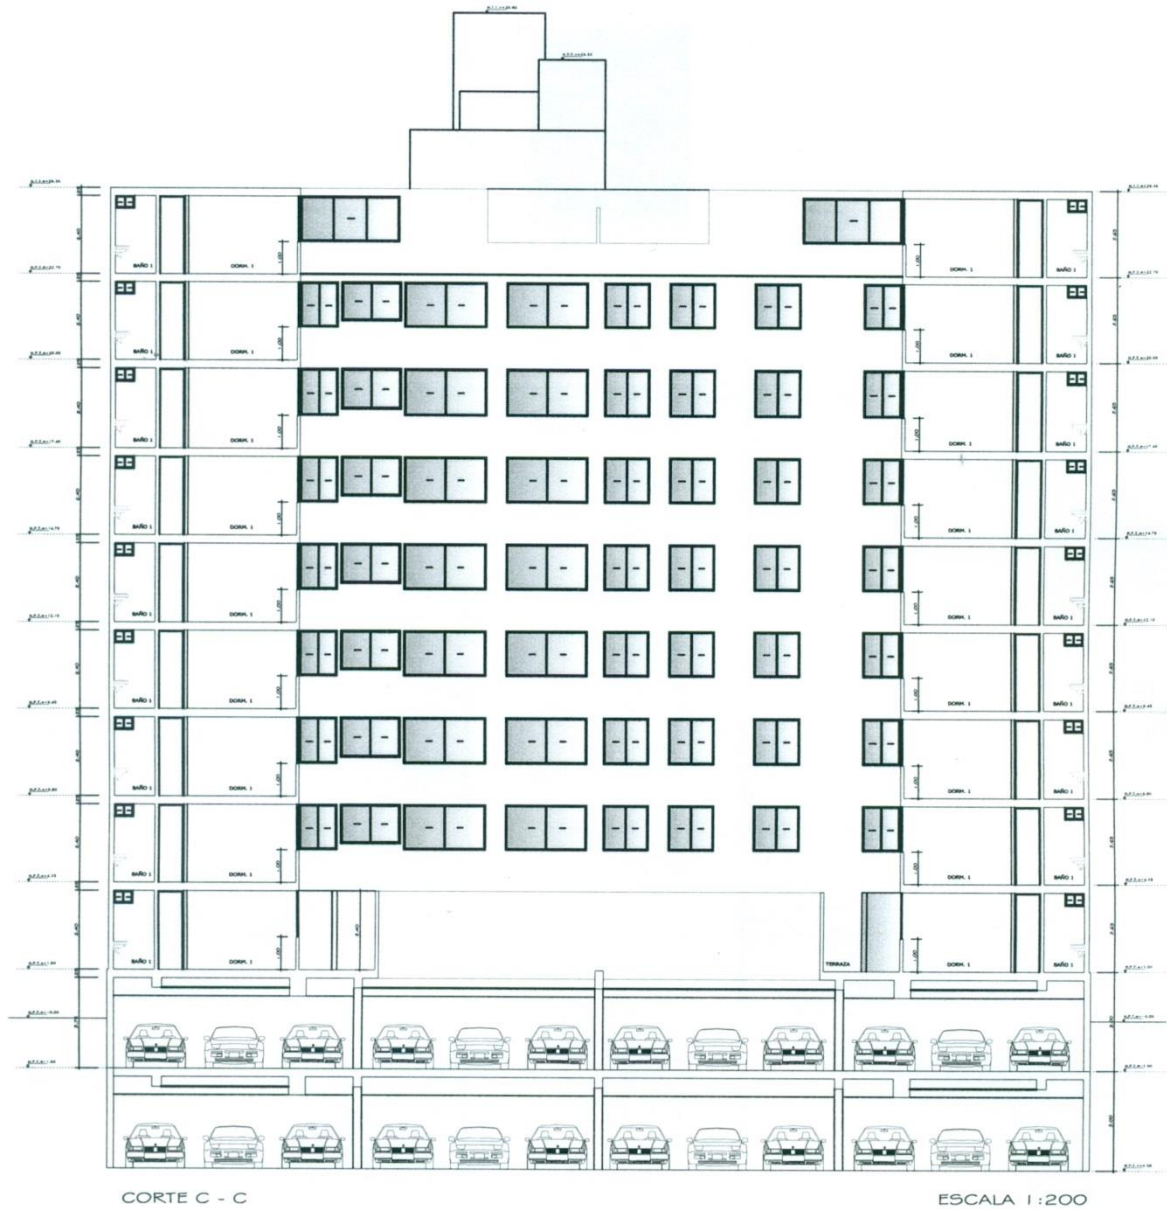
Plano del corte C-C, elevación posterior del proyecto Edificio Asturias
